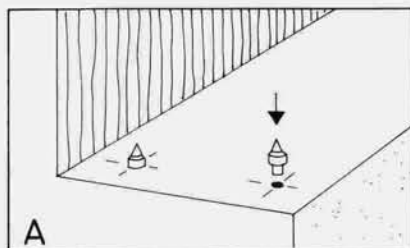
Крепление накладной проступи бетонной опорной лестничной конструкции
